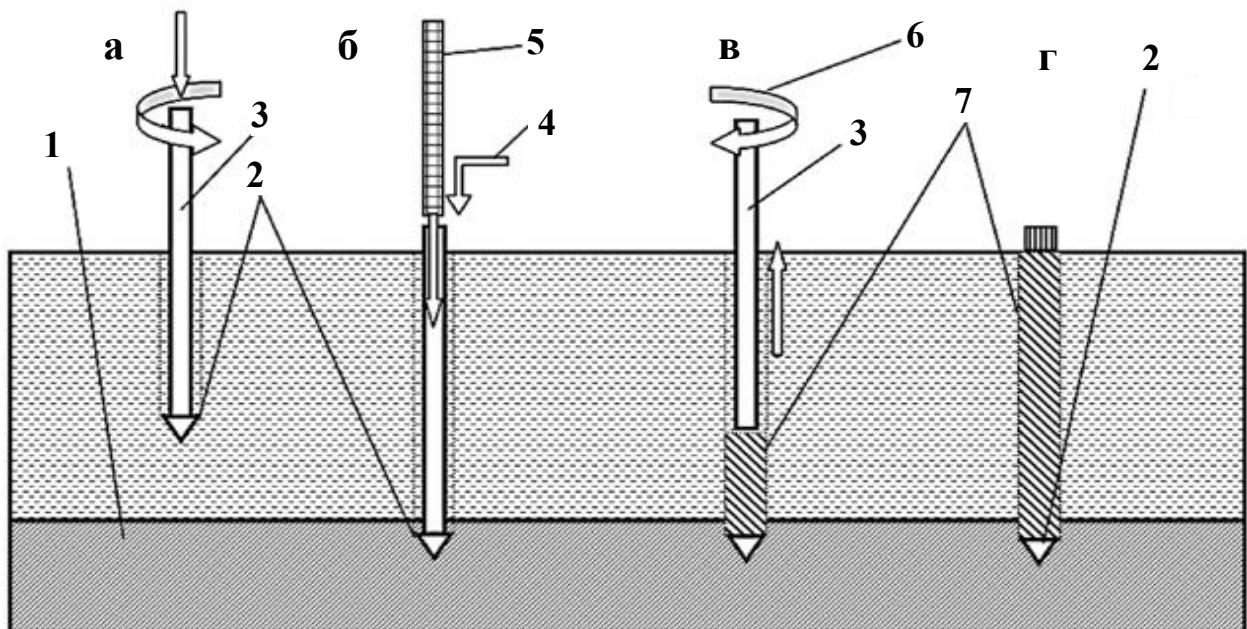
Технологічна послідовність влаштування палі: 1 – щільний ґрунт; 2 – башмак, що втрачається; 3 – обсадна труба; 4 – подавання бетону цебром або бетононасосом; 5 – арматурний каркас; 6 – напрям обертання обсадної труби; 7 – палія в ґрунті
